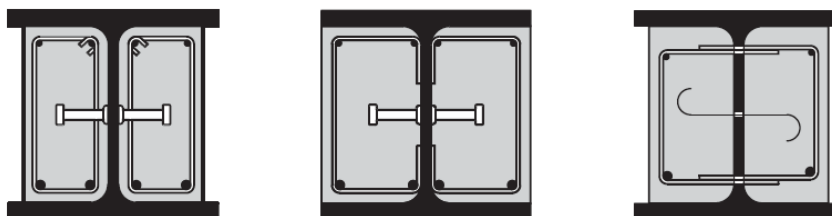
Disposições possíveis de reforço da armadura transversal [1]
